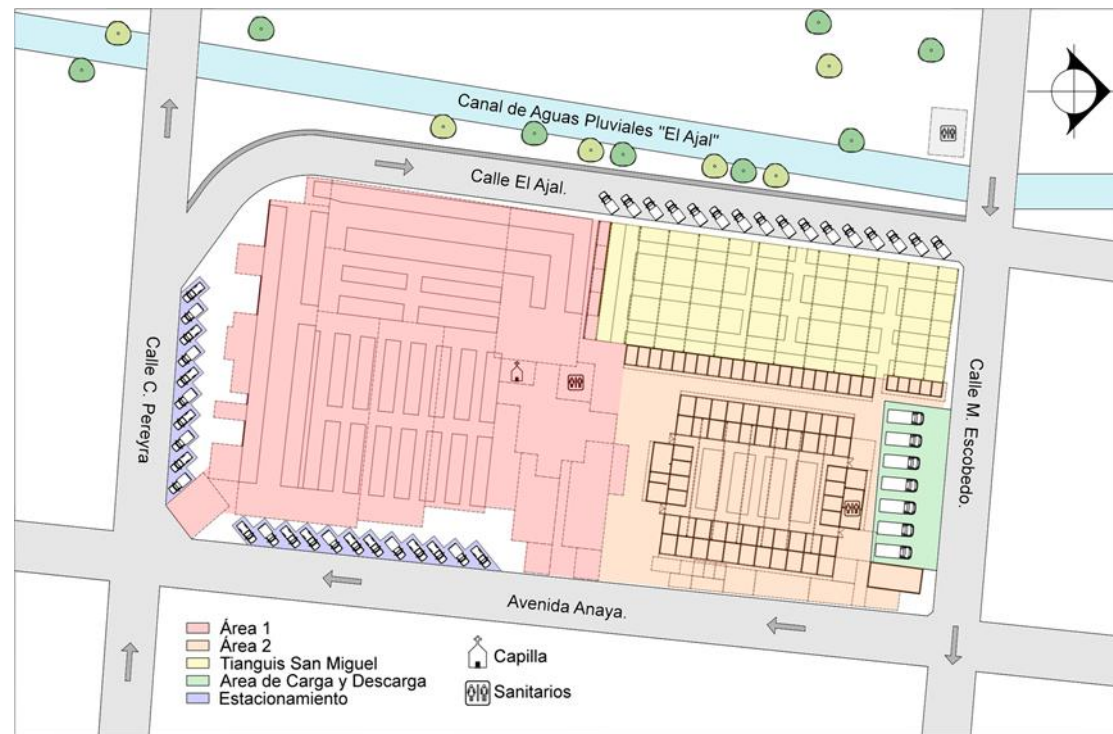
Levantamiento realizado en AutoCAD e intervenido en gimp noviembre 2012.
